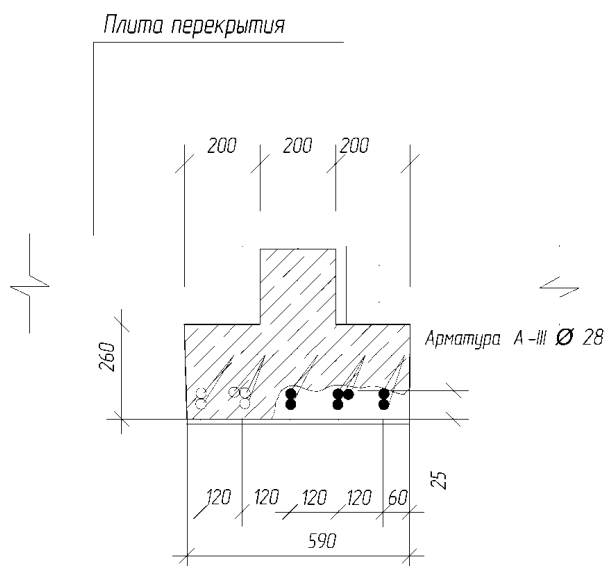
Сечение железобетонного ригеля (9 м)
